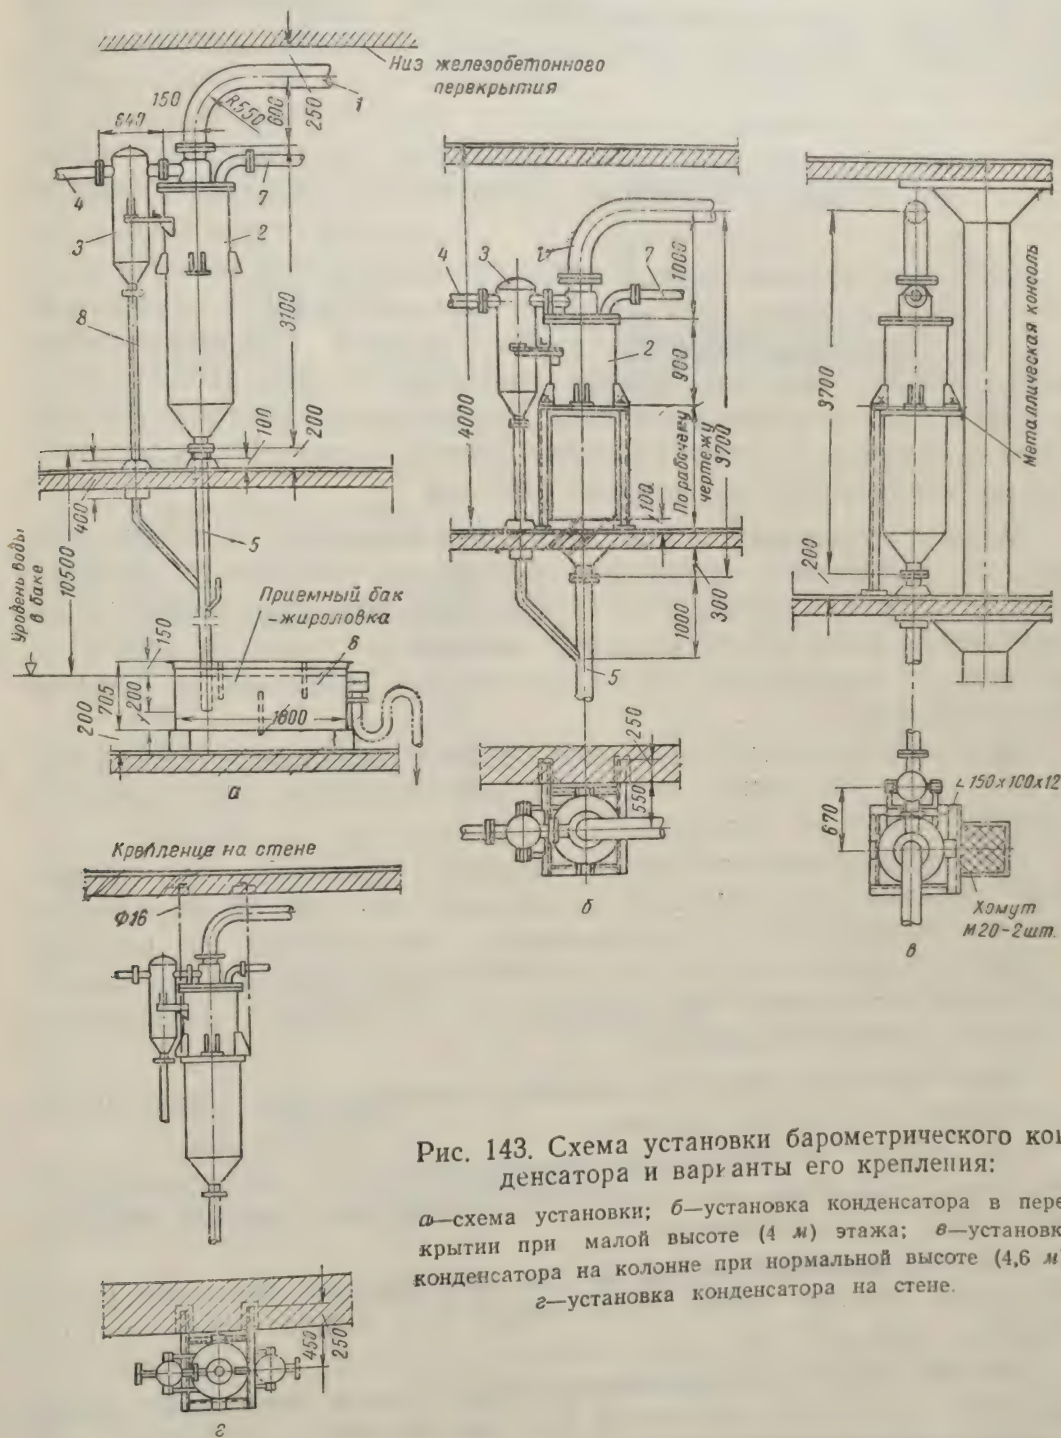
Схема установки барометрического конденсатора и варианты его крепления:
